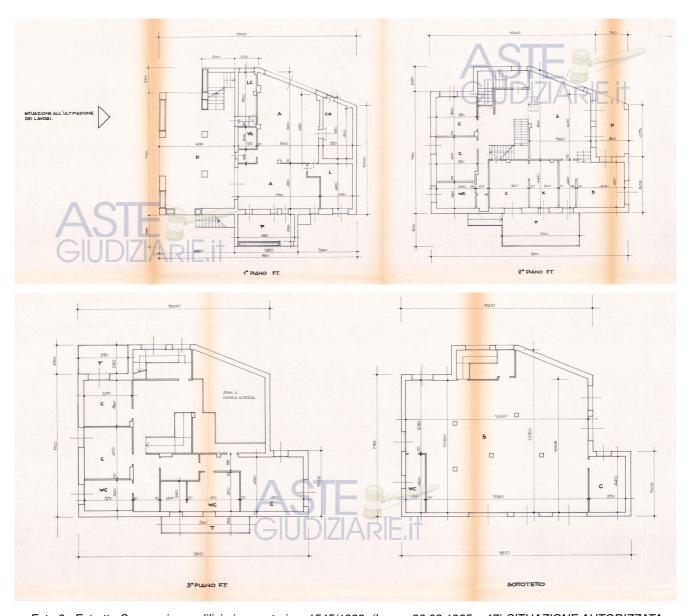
Estratto Concessione edilizia in sanatoria n.1545/1989 (Legge 28.02.1985 n.47) SITUAZIONE AUTORIZZATA
